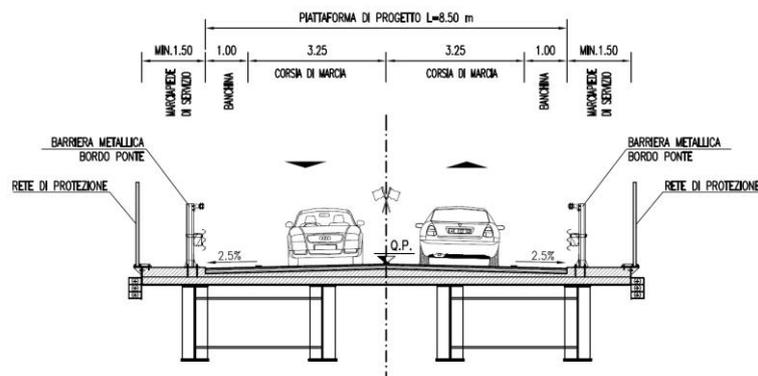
Sezione tipo su opera d'arte – Cat. F2 extraurbana locale
